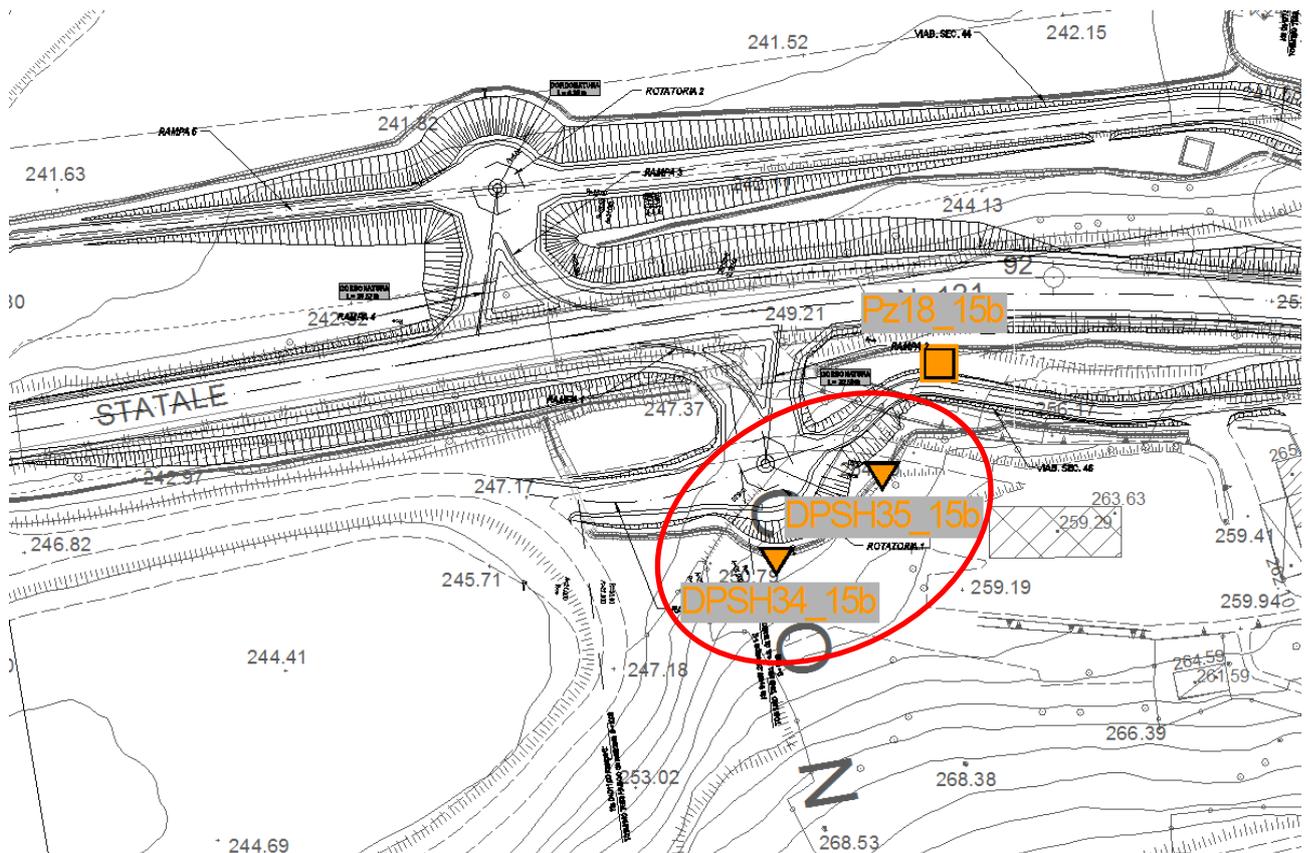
Planimetria con ubicazione indagini geotecniche disponibili.
